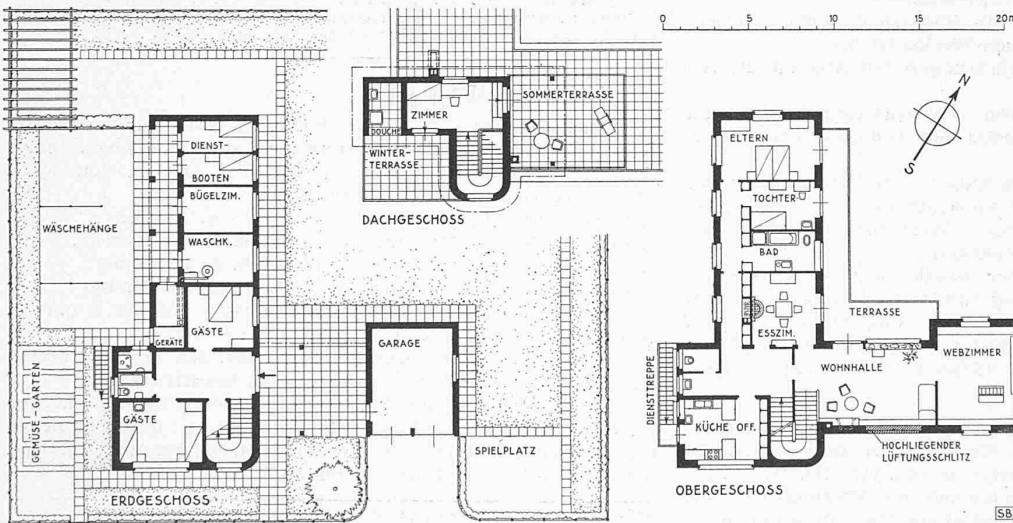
Wohnhaus in Maadi bei Kairo. Grundrisse 1: 400
